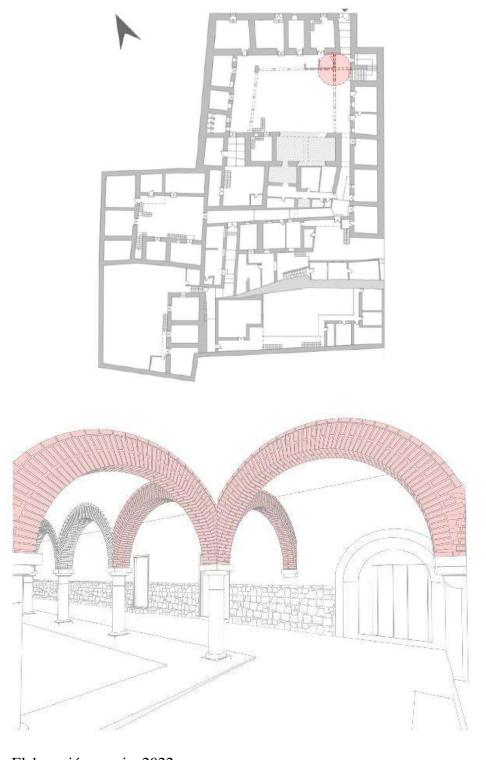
Encuentro de Cuatro arcos, entre la Galería Norte y Galería Este
